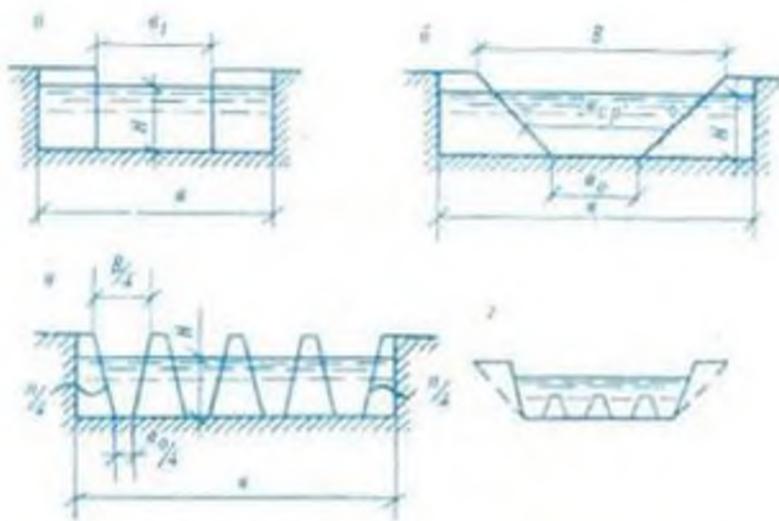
Формы поперечных сечений открытых перепадов: а — прямоугольная; б — трапецидальная; в — щелевая; г — гребенчатая; б₀ — ширина русла (на входе).
